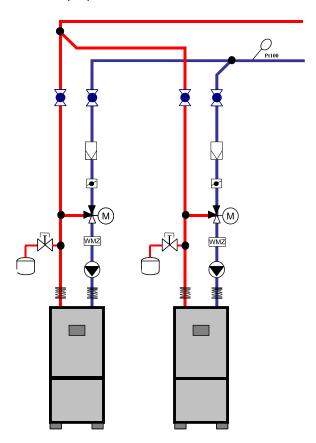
Schema di collegamento dell'allacciamento idraulico.
